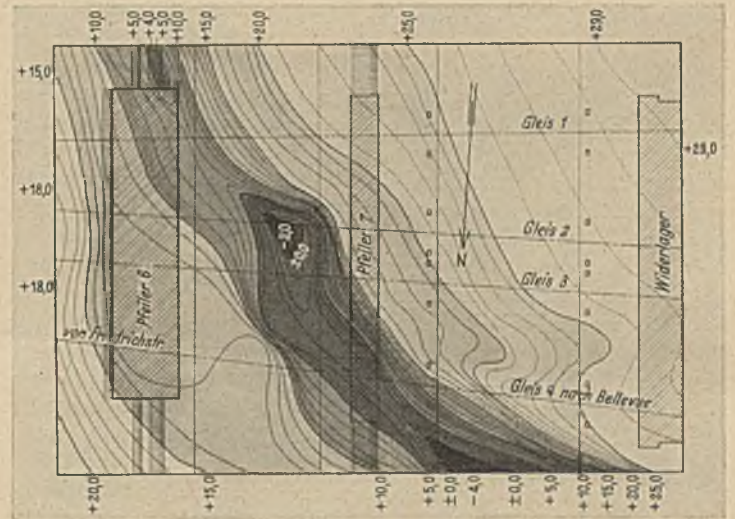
Tiefenlage des guten Baugrundes (Höhenlinien über NN.)
